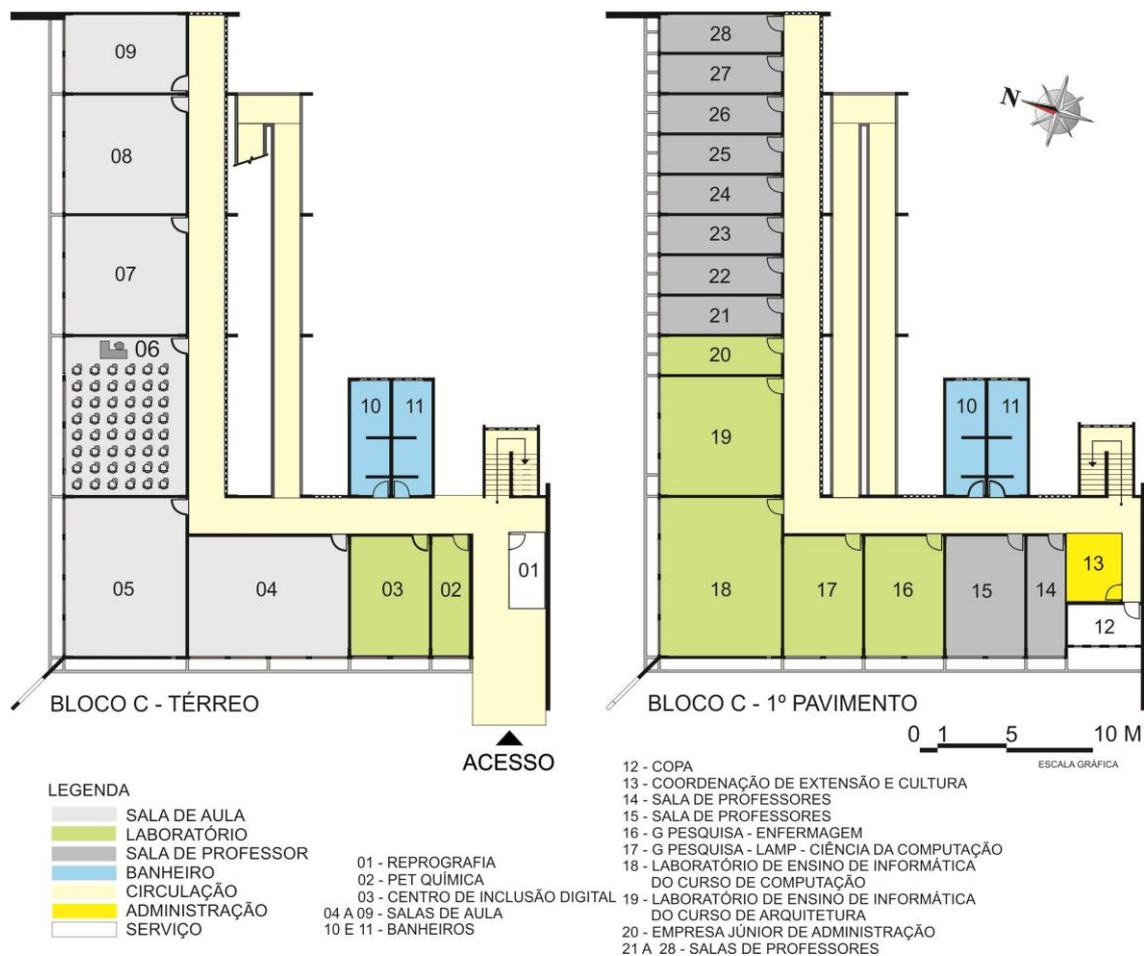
planta de usos do Bloco C – pavimento térreo e superior
